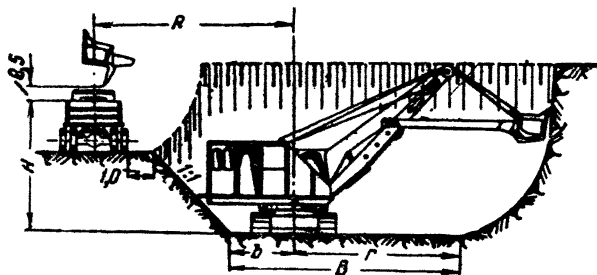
Поперечное сечение экскаваторного забоя при разработке выемок и карьеров продольными проходками
